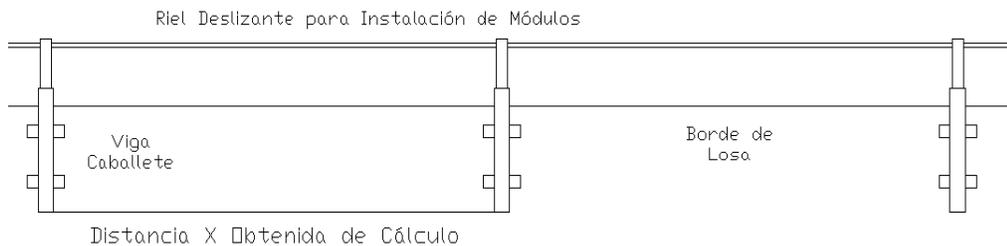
Vista en Planta de Sistema de Viga Caballete
